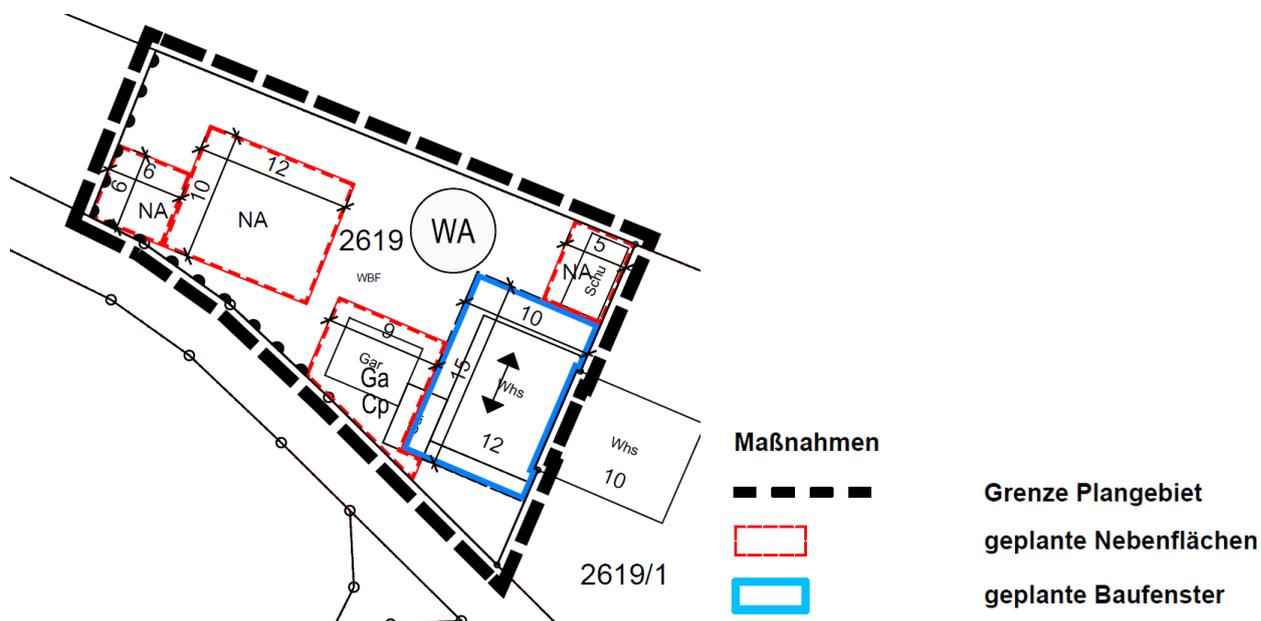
Maßnahmenplan (galaplan decker, Stand: 20.01.2025)
